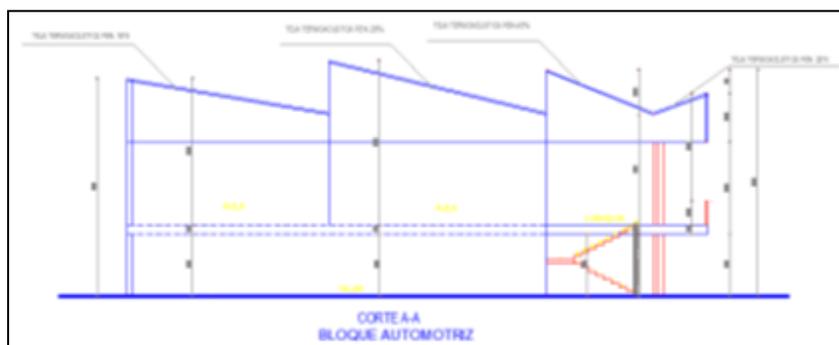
Estructura 2. Corte A-A de la Edificación.
